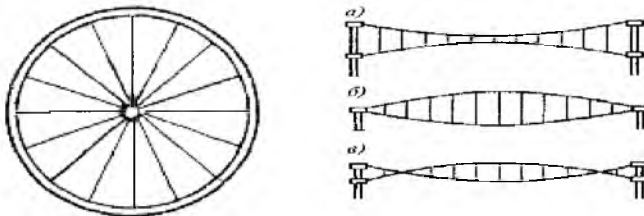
Расчетная схема круглого в плане покрытия с двухпоясной системой
